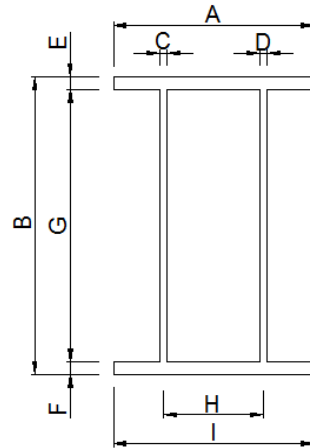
Esquema de Viga con Alma Doble (Double-Web Beam)
